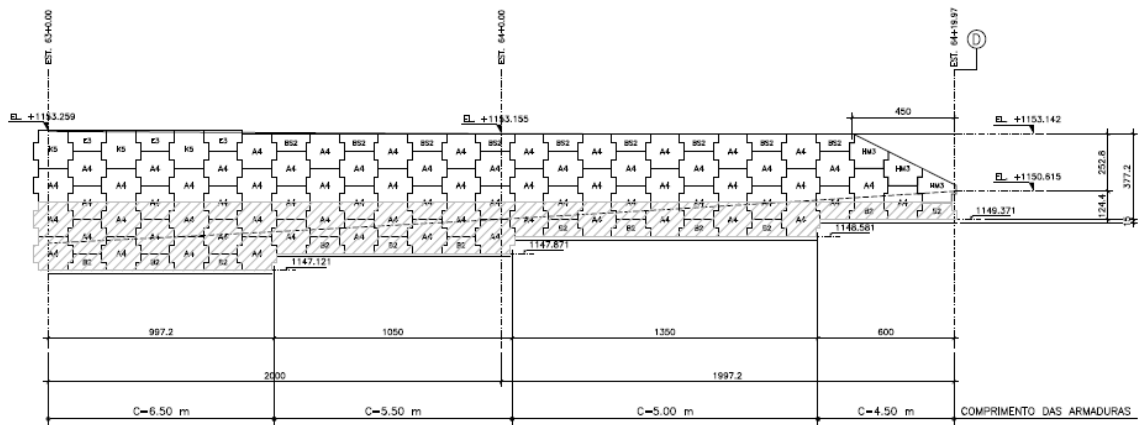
Elevação Solo Reforçado Eixos CD-2
